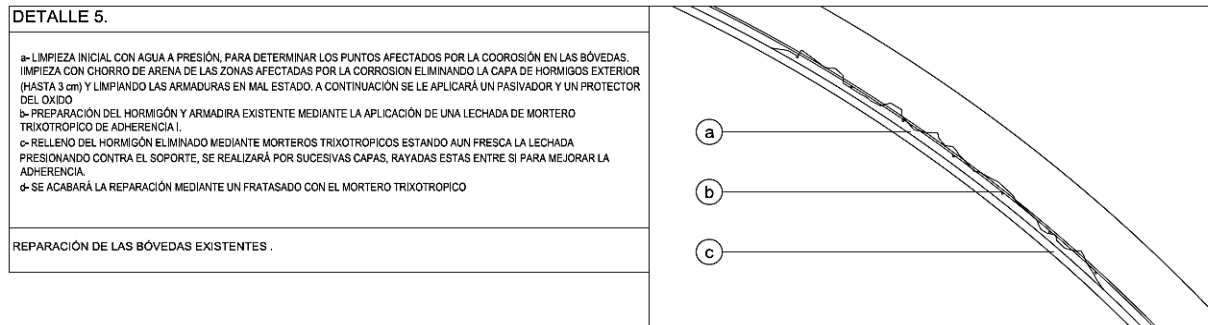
Detalle reparación bóvedas hormigón armado. Villa el Castillito. Sanlúcar de Barrameda. Cádiz. (Fuente: Tragsatec) [86]
